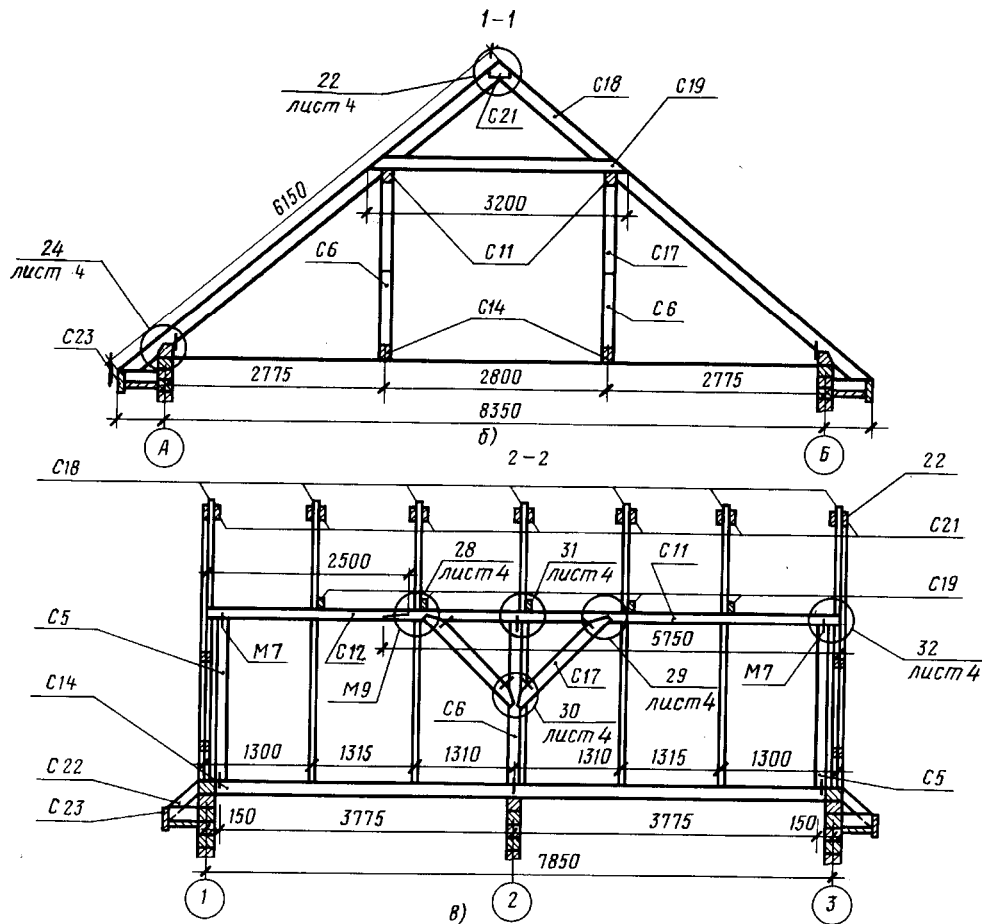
Монтажна схема конструкцій насланих крокв одноповерхового житлового будинку:
